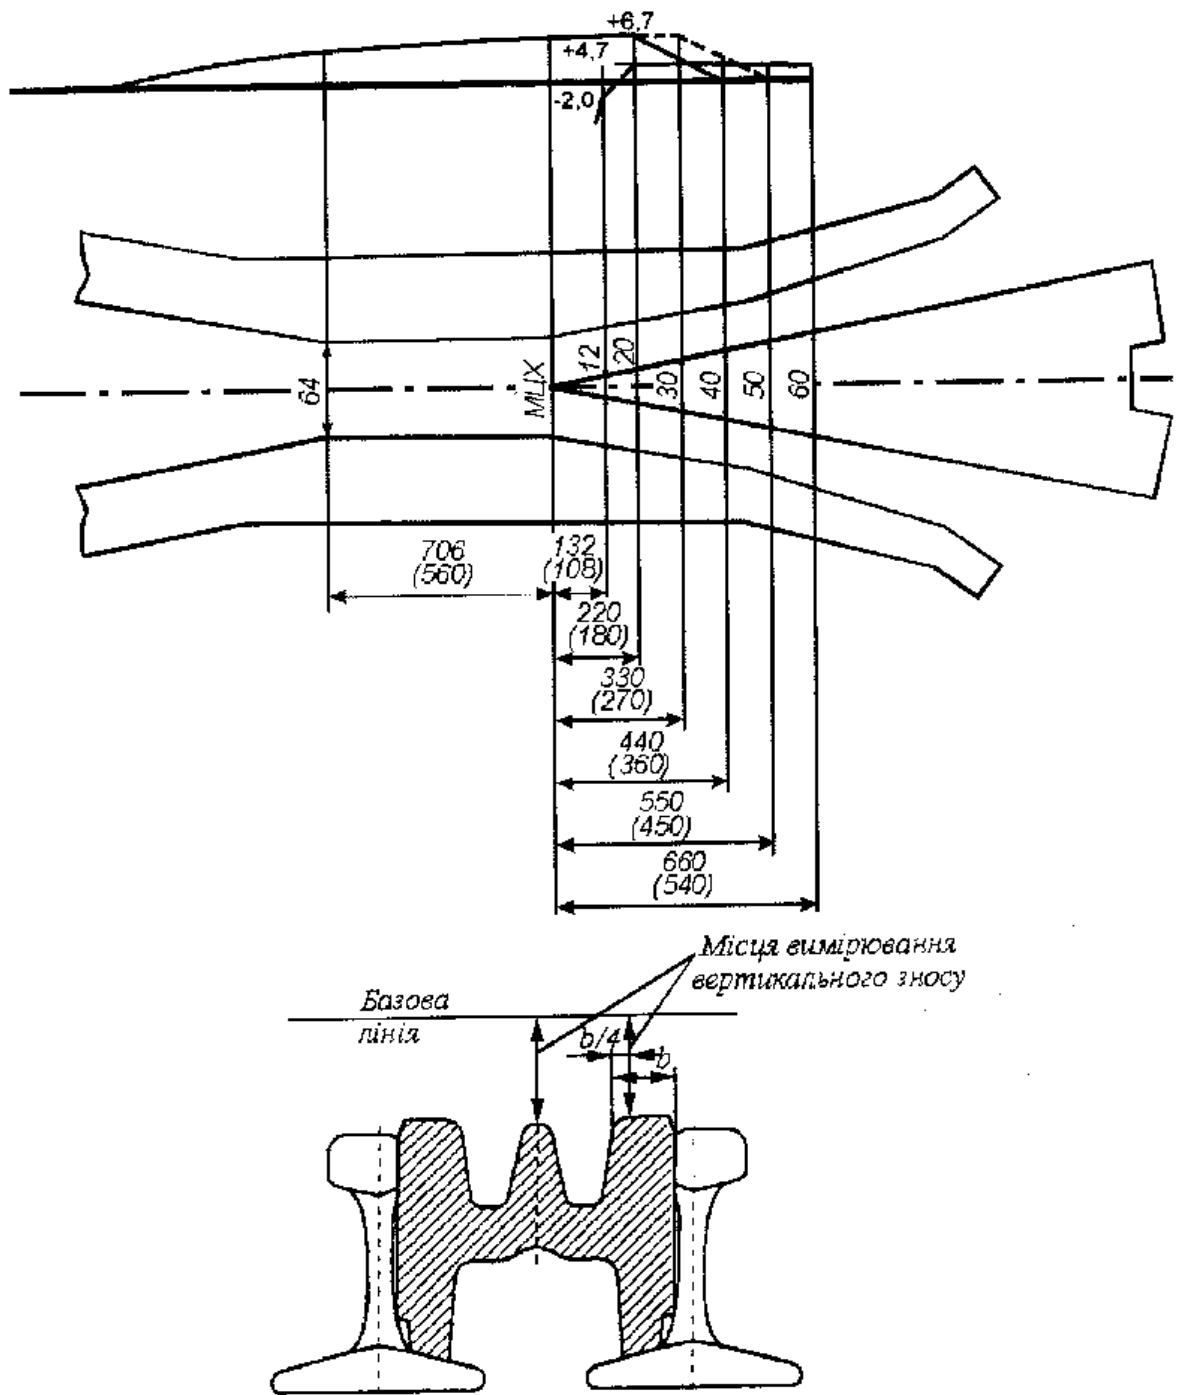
Схема измерений продольного профиля крестовин стрелочных переводов типа Р65 марок 1/11 и (1/9) на железобетонных брусках [19]
